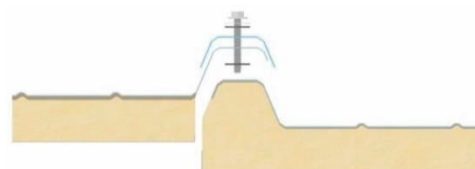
Detalle panel Foilroof. Encastre - solape de crestas.
